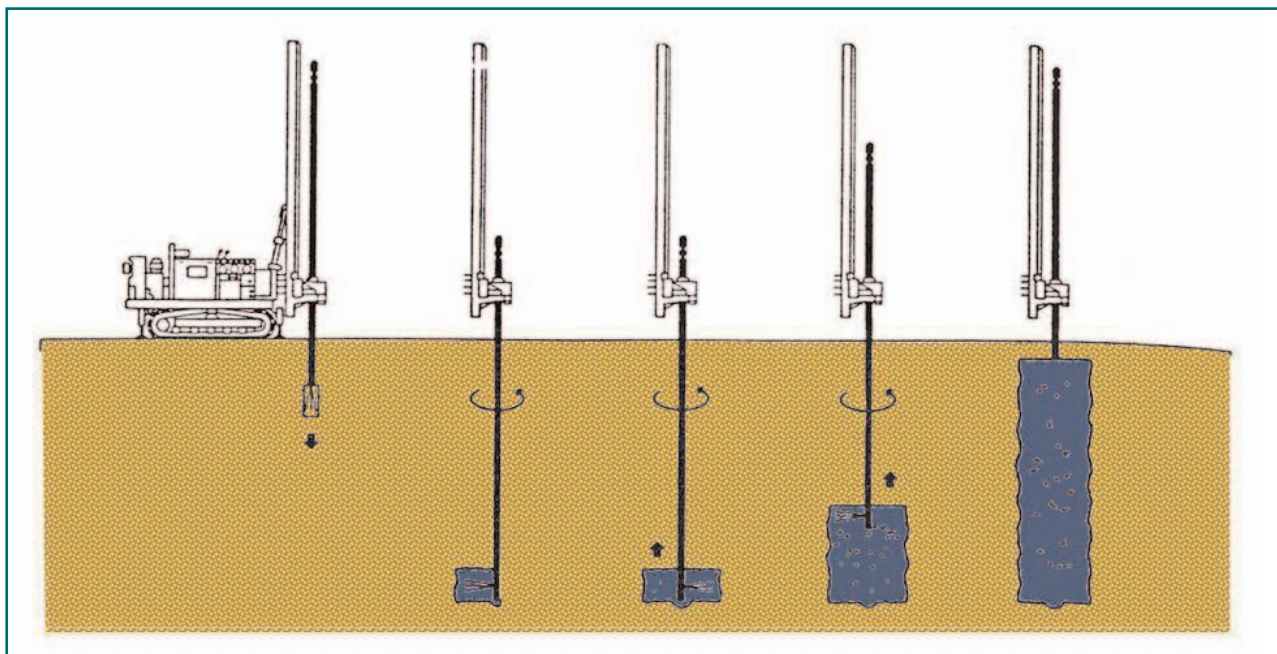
Esquema de la realización de columnas de jet-grouting.
